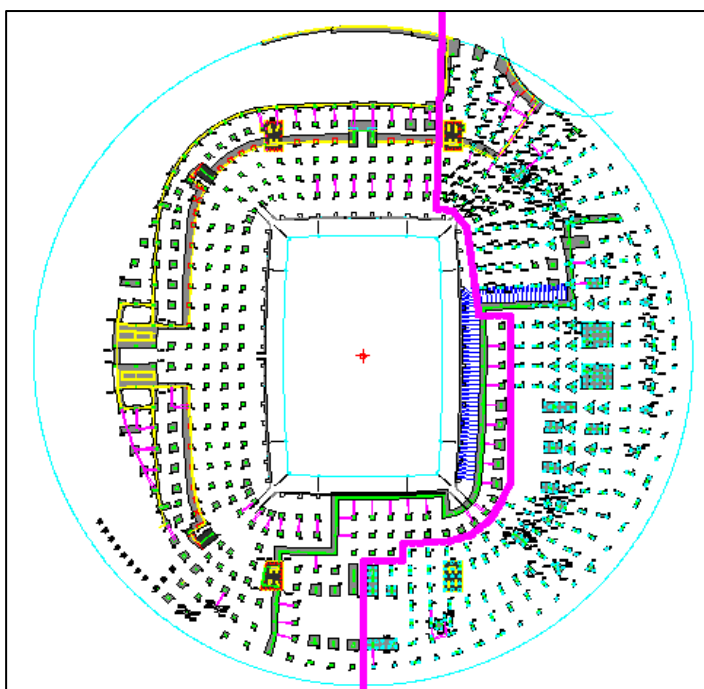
Planta de fundações do Estádio do Dragão. (GEG)
